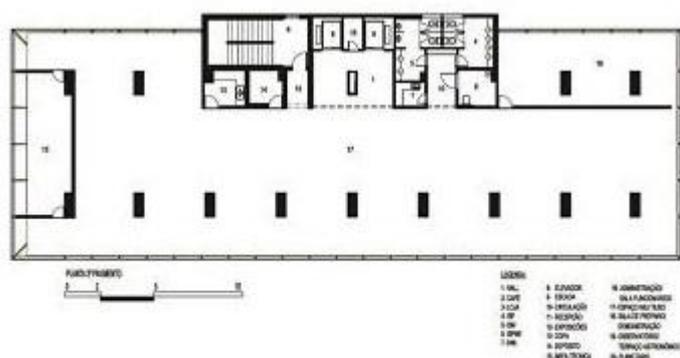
Planta do 4º pavimento – onde fica a parte da exposição *Origens
